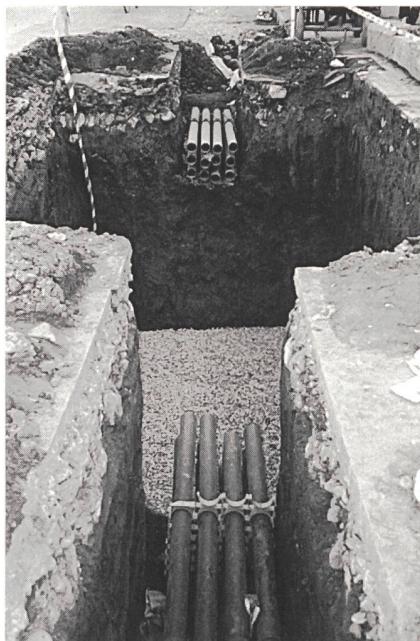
Bau des Trassees für das Primärnetz mit vorgesehenem Zugschacht
